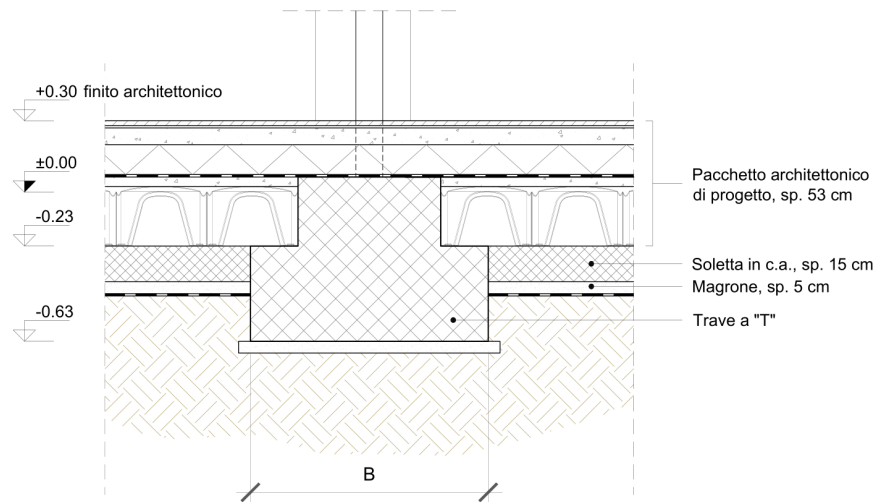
Dettaglio trave di fondazione (sezione trasversale).
